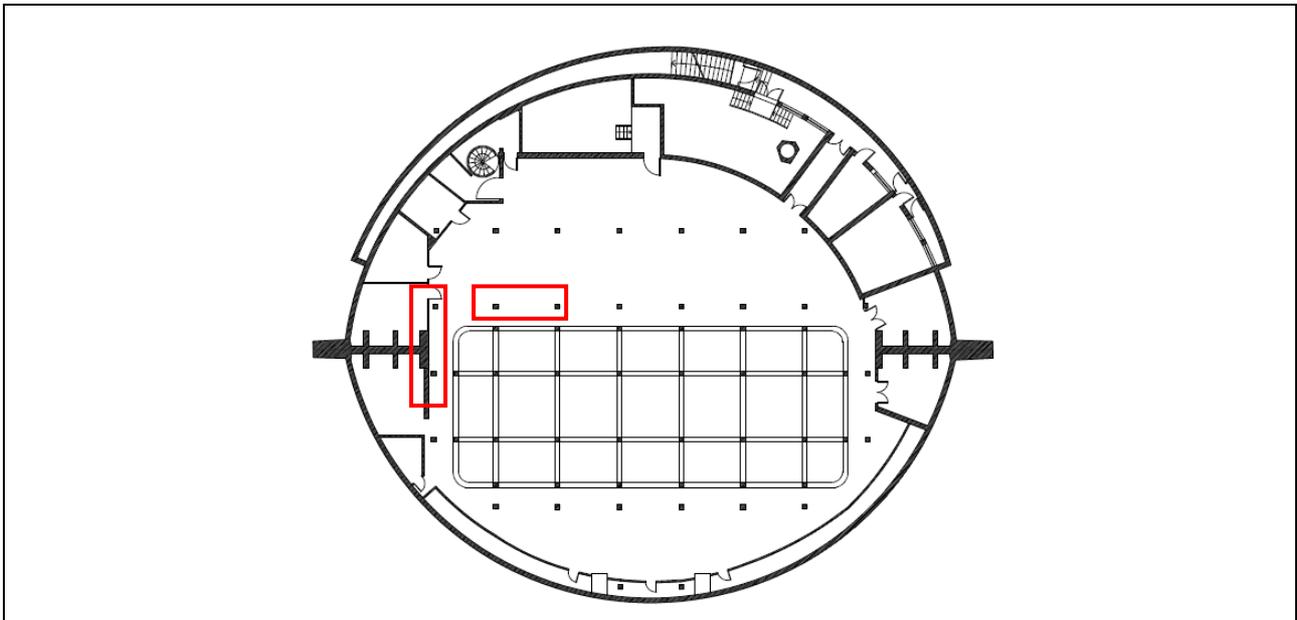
Travi gravemente danneggiate dalla corrosione
